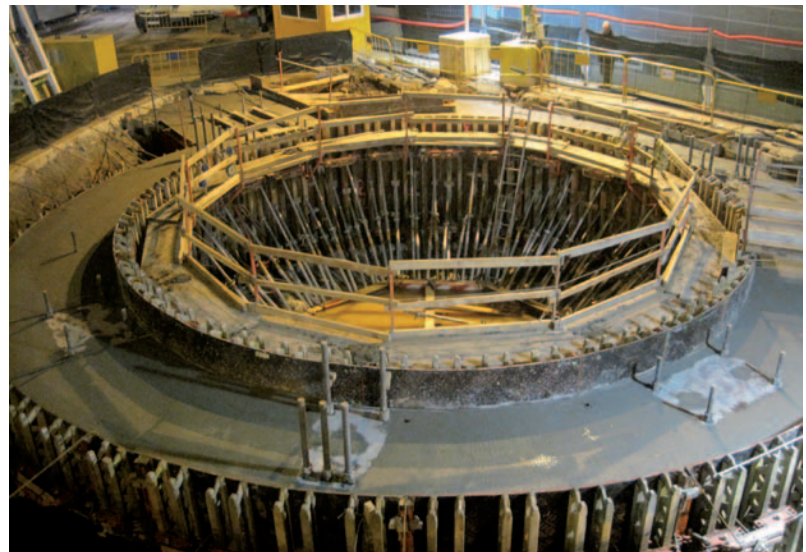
Viga de atado: encofrado interior, refuerzo y viga terminada/Ring beam: interior lining, reinforced steel and finished concreting.
